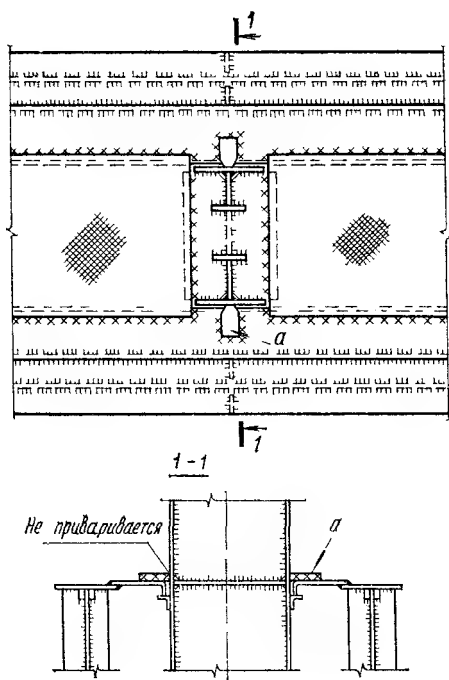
Сопряжение неразрезных подкрановых конструкций с колонной в уровне верхнего пояса
